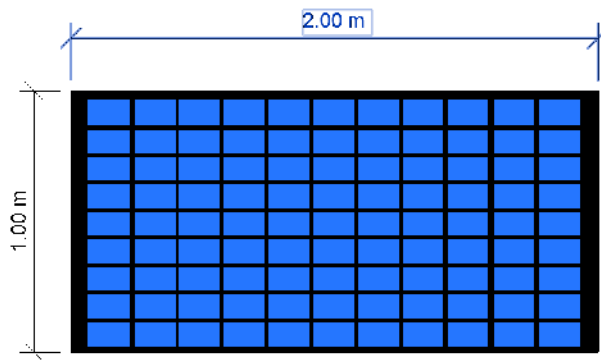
VISTA EN PLANTA DE PANEL FOTOVOLTAICO PROPUESTO.
